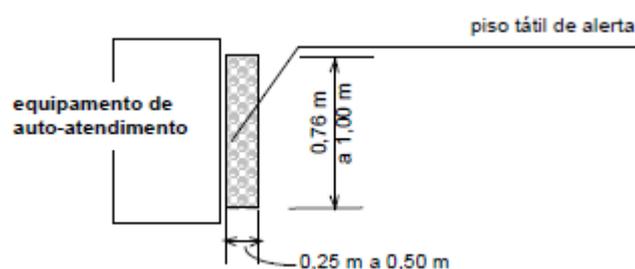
Piso tátil no equipamento de autoatendimento - Planta
